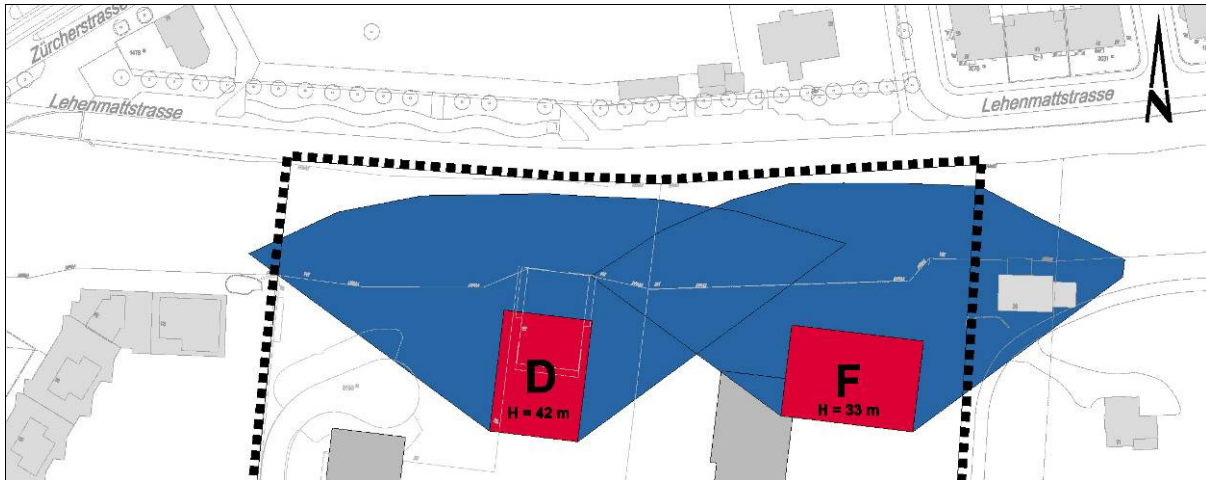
Situationsplan. Stump & Schibli Architekten, August 2012 (Kein Massstab, Plan genordet)
